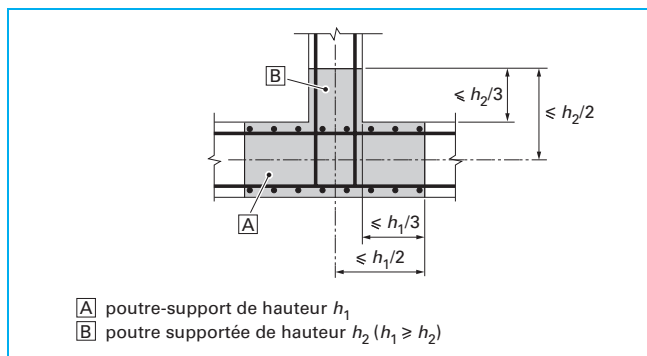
Armatures de suspension dans la zone d'appui mutuel de deux poutres (figure 9.7 de l'EC2)
